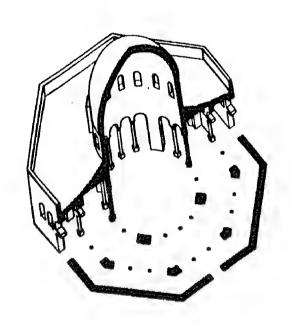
ـ مسقط لجامع شهزاد باستنبول
